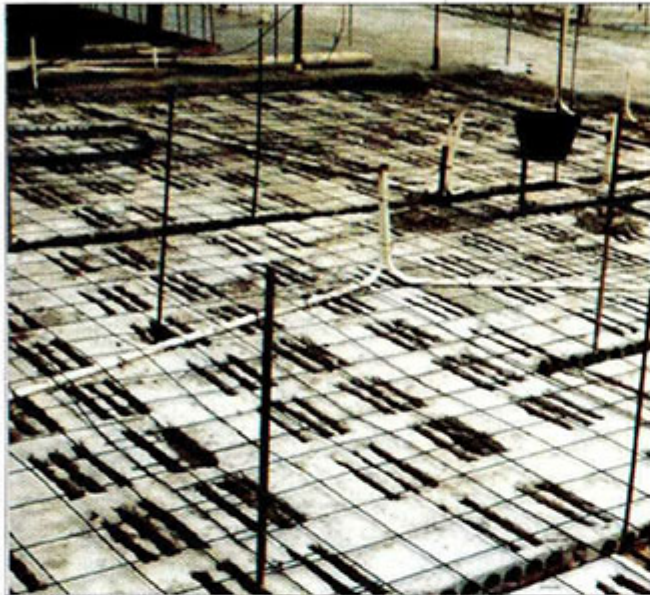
Losas previas planas para la construcción de placas de concreto en dos etapas, hechas de cefiplás reforzado.
